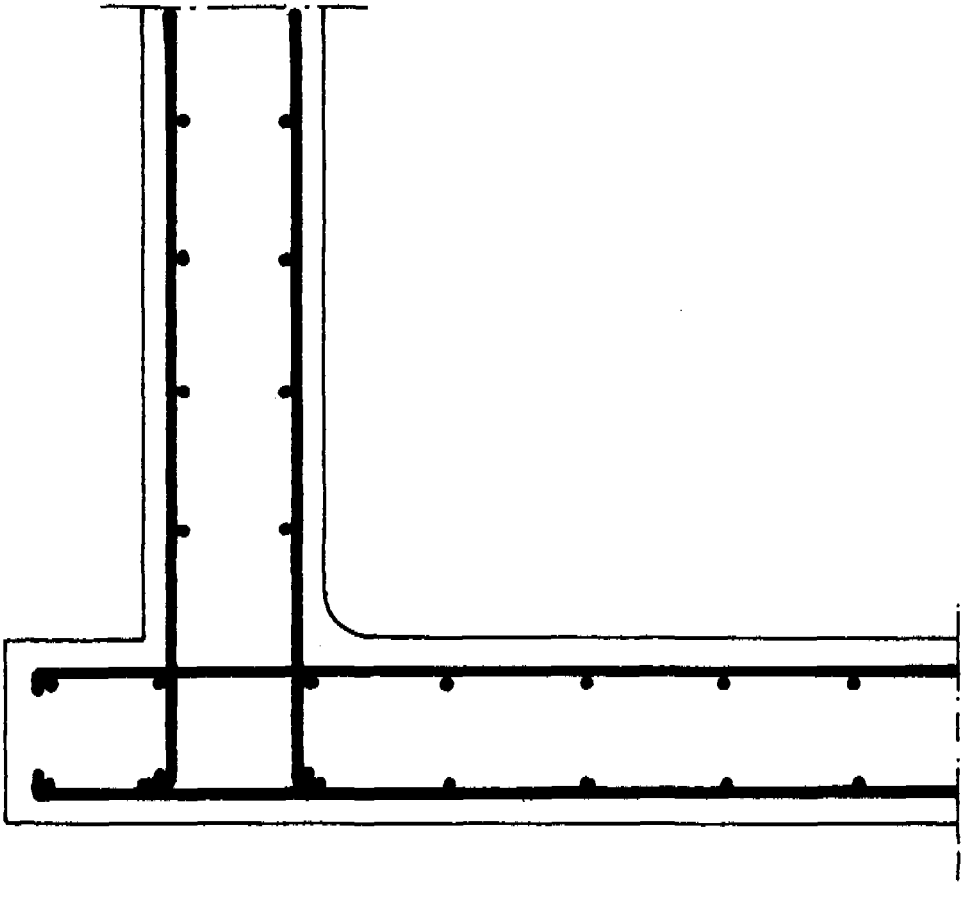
Ejemplo de diseño de refuerzo para conexión de pared y piso.
